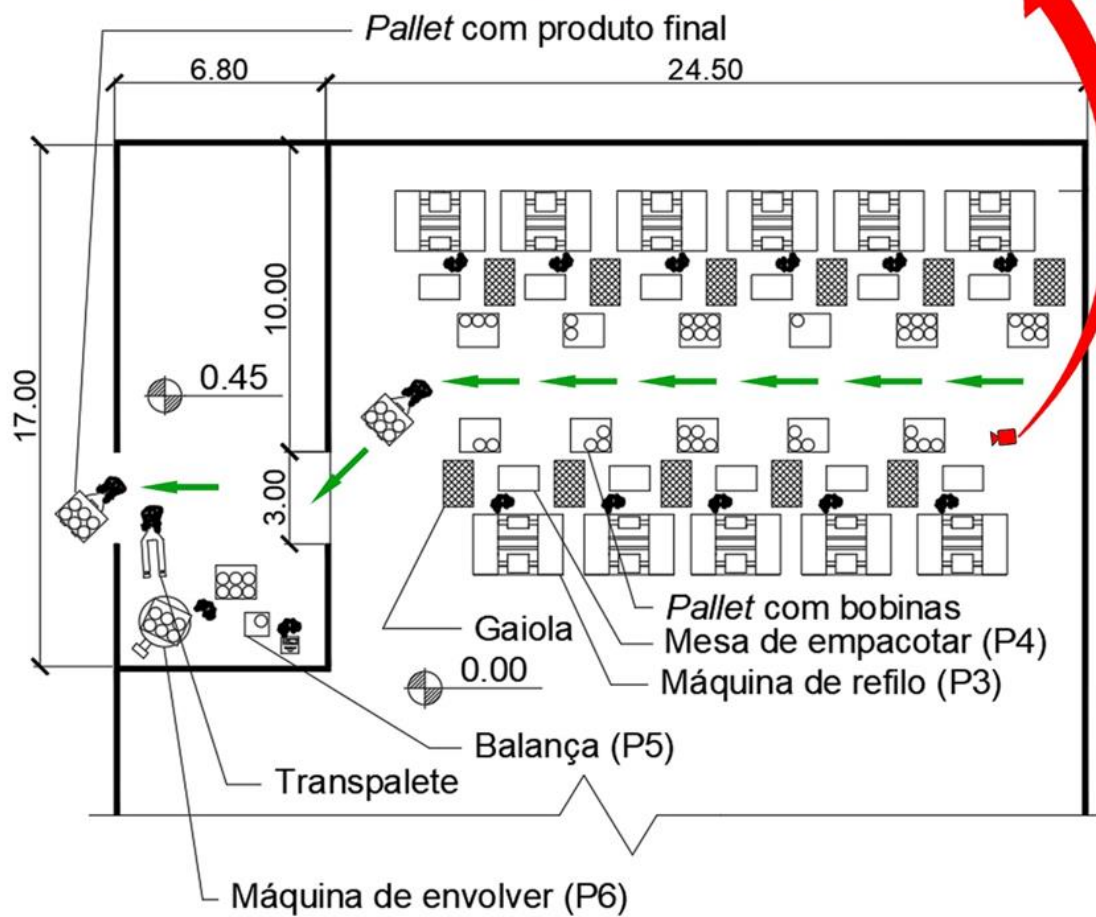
Planta dos setores de refilo, empacotamento e pesagem.
